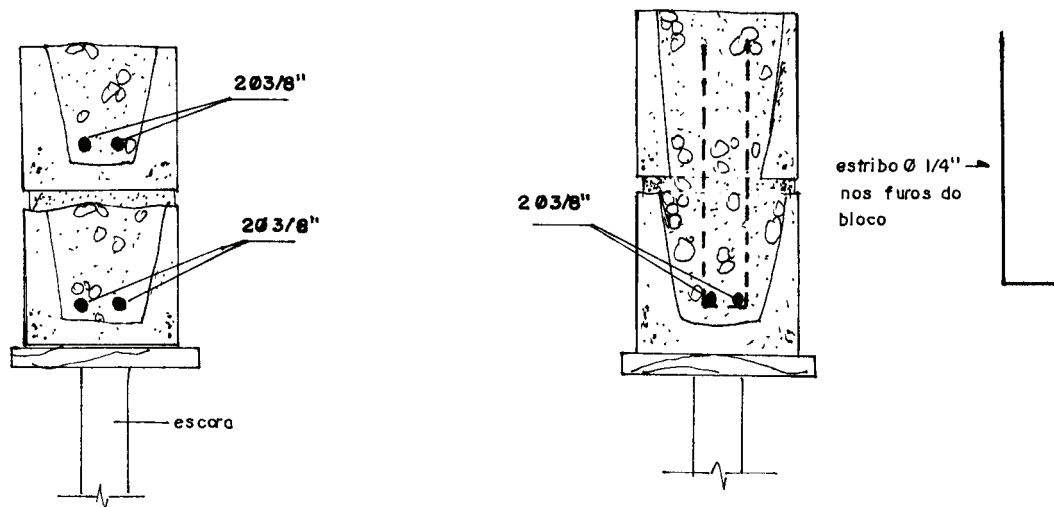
Vergas em alvenaria de tijolo maciço para vãos entre 1,50m e 2,00m
